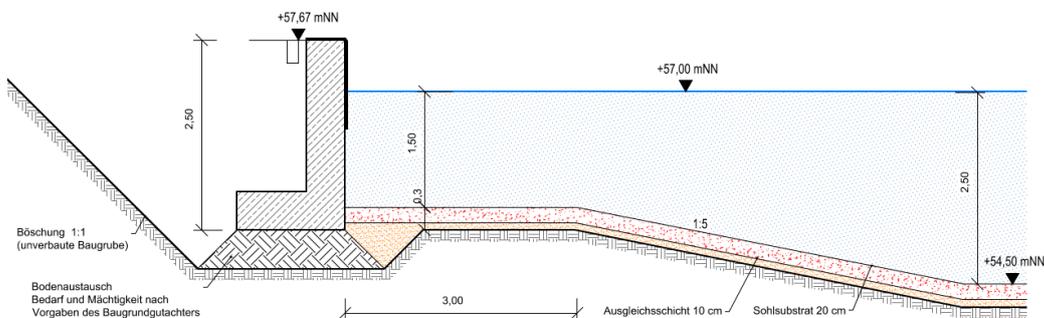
Variante 1 unabgedichteter See mit Ortbetonwand
